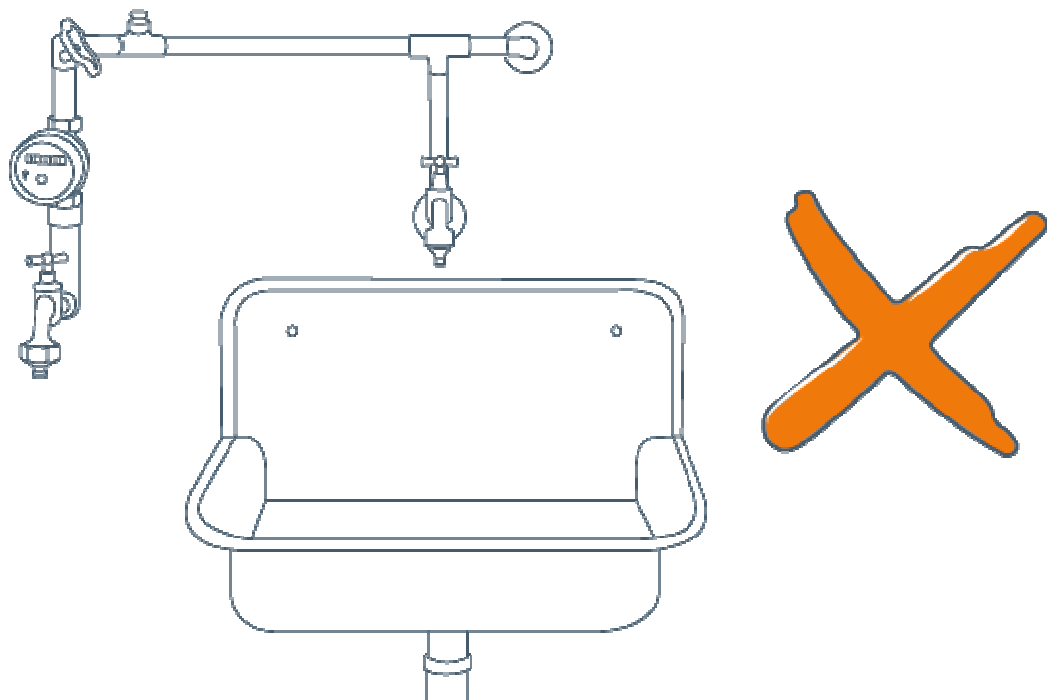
Fehlerhafte Installation: Außenwasserhahn befindet sich in gleichem Raum mit Kanalabflussmöglichkeit (hier: Waschbecken)
